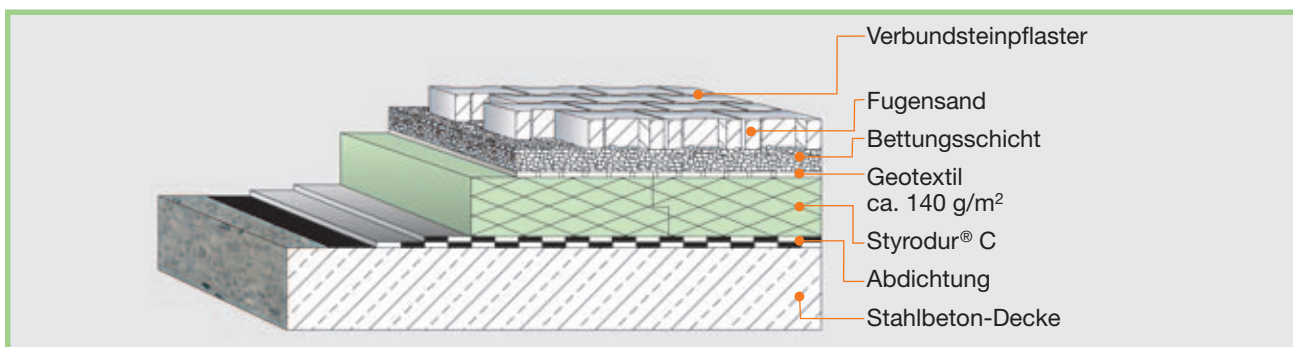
Parkdachaufbau mit Verbundsteinpflaster auf einer Bettungsschicht.
